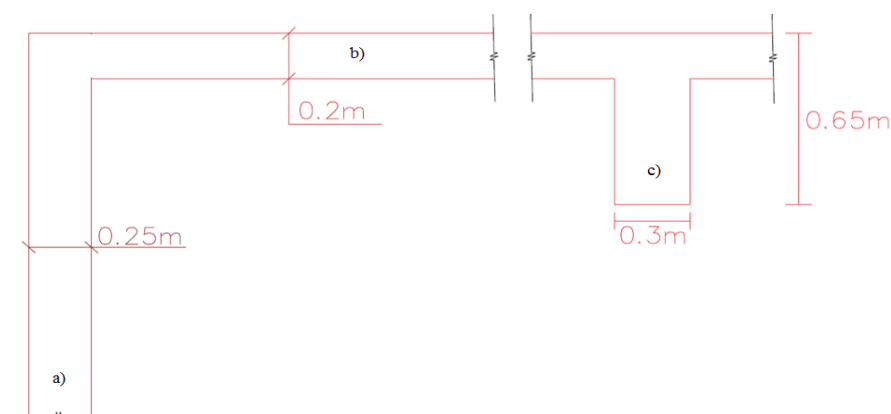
Representação das dimensões dos elementos estruturais consideradas no presente trabalho. Em que a) muro, b) laje e c) viga.
